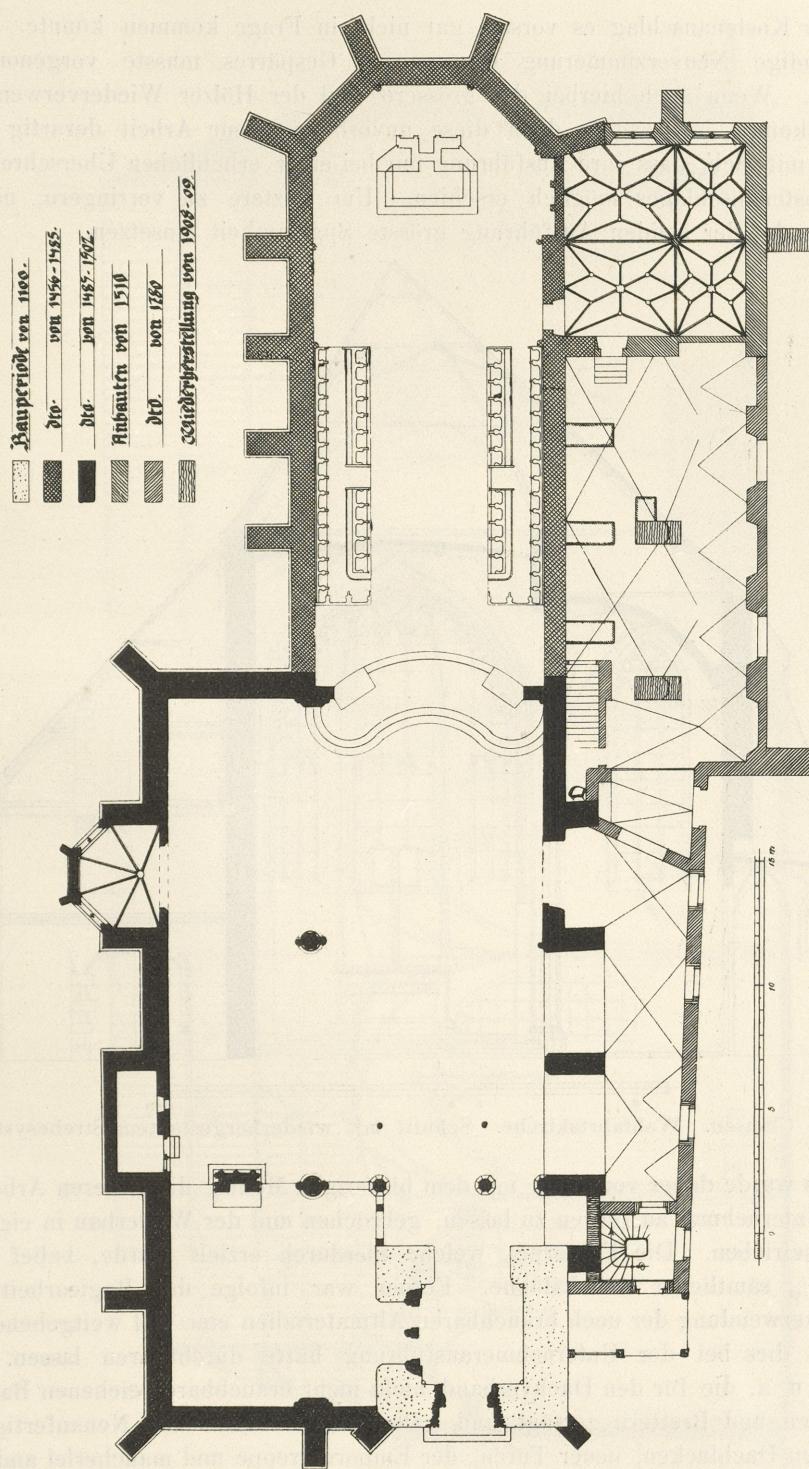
Clausen. Wallfahrtskirche. Unterer Grundriss nach der Wiederherstellung.
